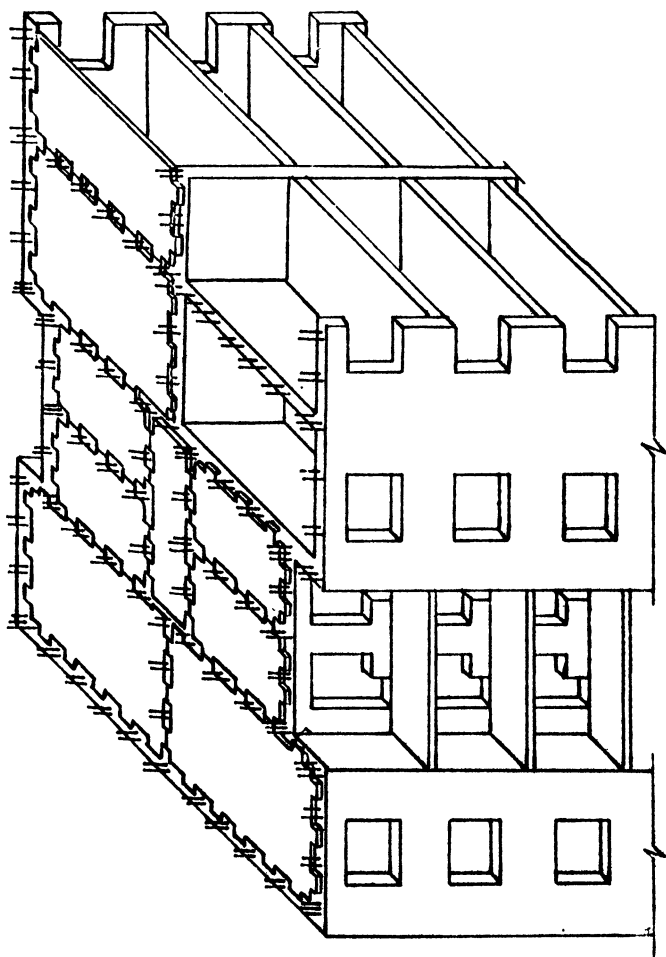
Здание перекрестно-стеновой конструктивной системы с несущими наружными монолитными стенами
